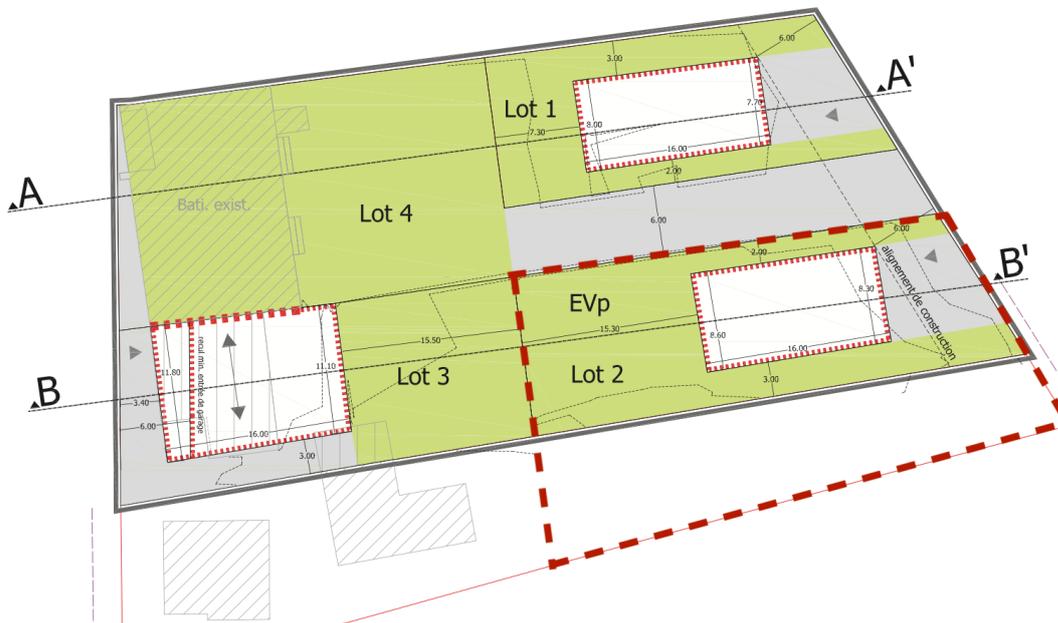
Plan et coupes de la MOPO dressés par pact sàrl, Avril 2019
